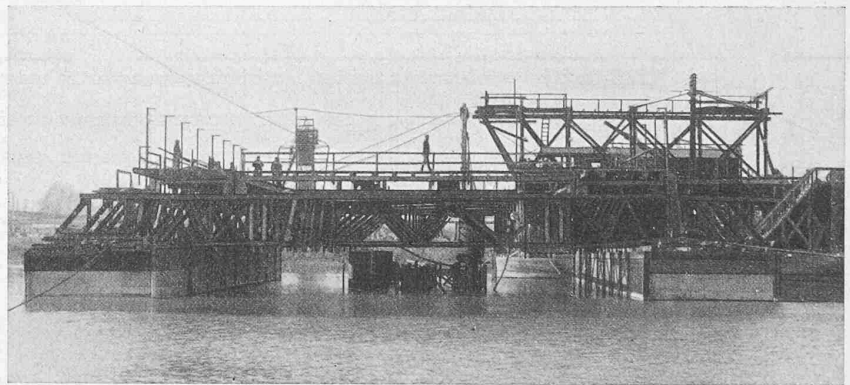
Schwimmgerüst des beweglichen Caisson.
